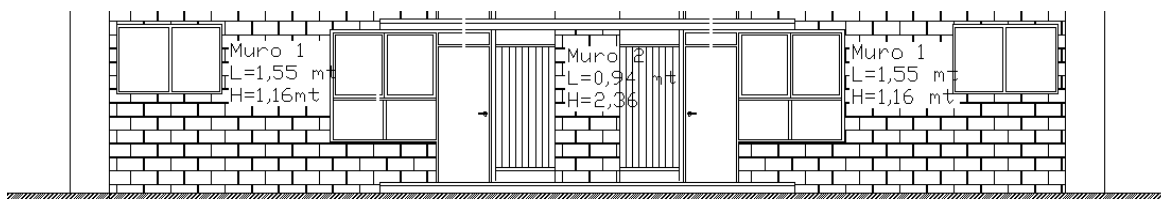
35. Fachada Eje X, edificio 5 pisos
